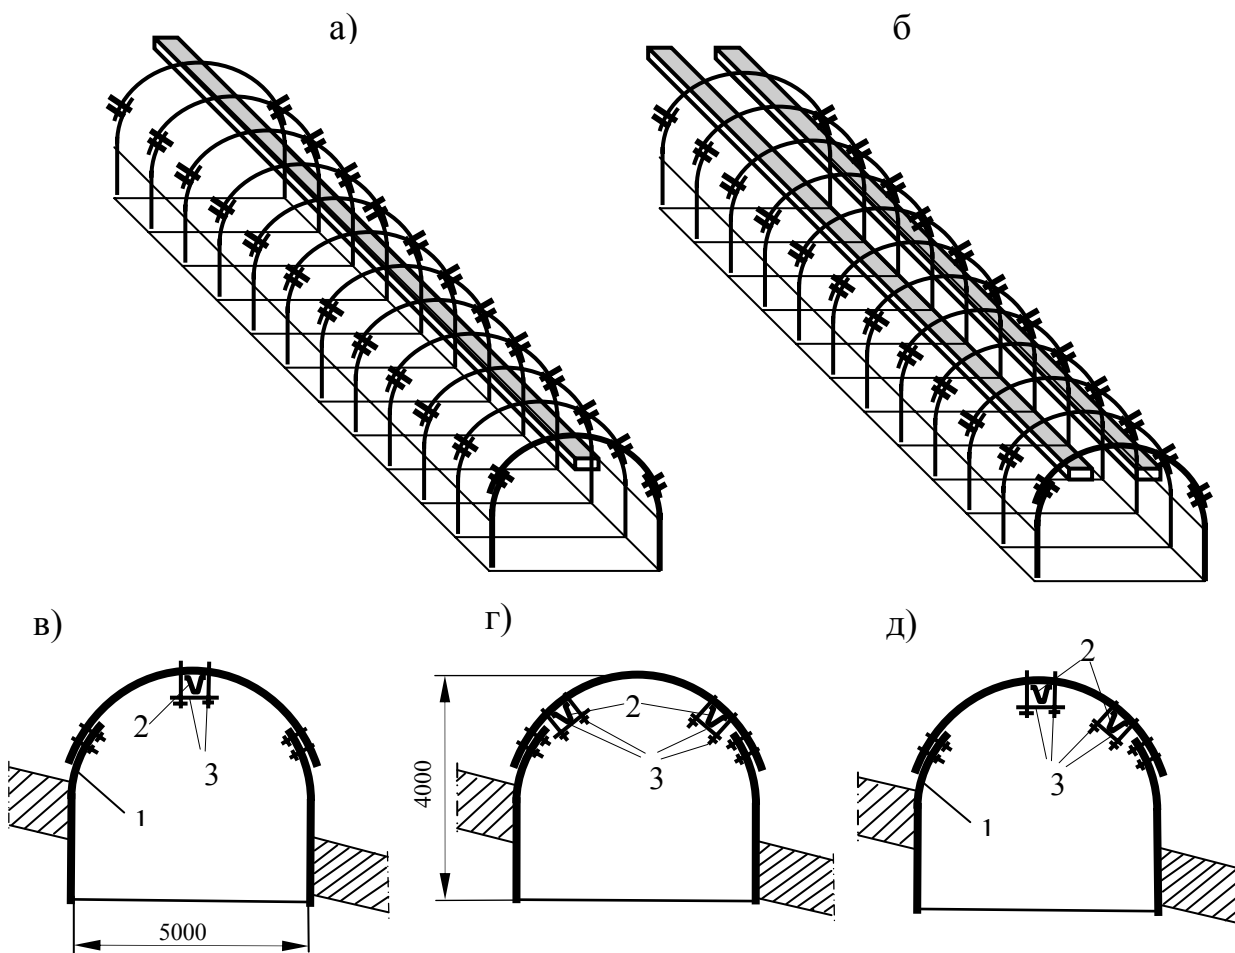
Схема расположения одно- и двухбалочных продольно-жестких крепей усиления по длине (а,б) и в поперечном сечении выработки (в, г, д): 1 – комплект арочной крепи; 2 – продольные балки из спецпрофиля СВП-27; 3 – металлические планки и крепежные крючья с гайками
